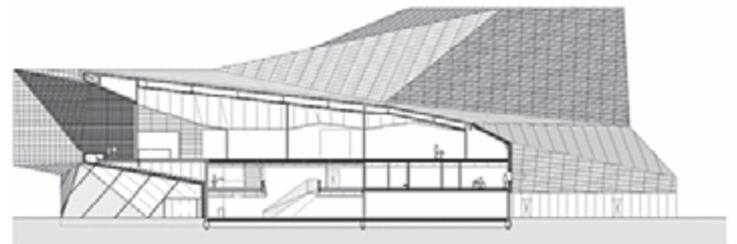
Sezione longitudinale sul foyer.
